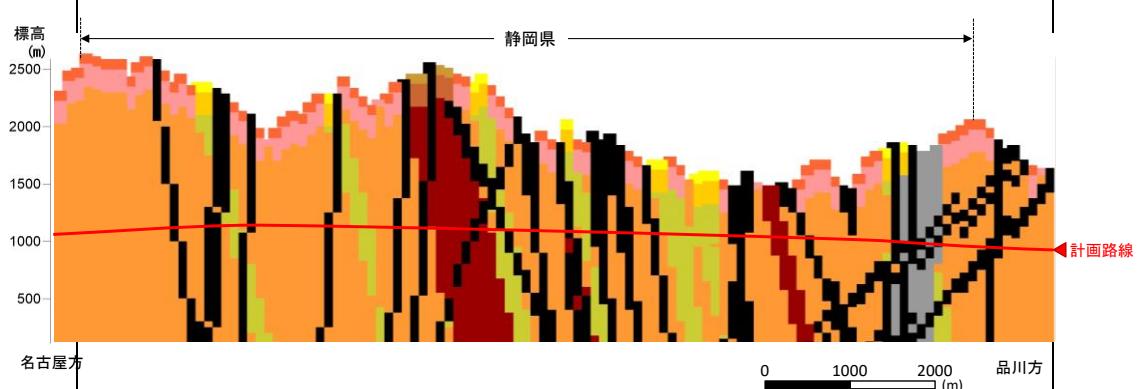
JR 東海モデル 地質断面図 (静岡県付近)
